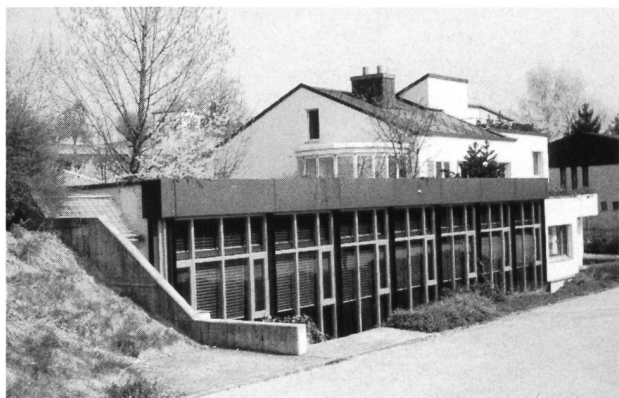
Dieser längliche eingeschossige Bürotrakt (10 x 20 m) in Jona (SG) ist an ein bestehendes Wohnhaus angebaut worden. Das ganze Gebäude ist erdbühnt und erdbedeckt, so dass das Gelände über dem Bürotrakt wieder als Grünfläche dient.
